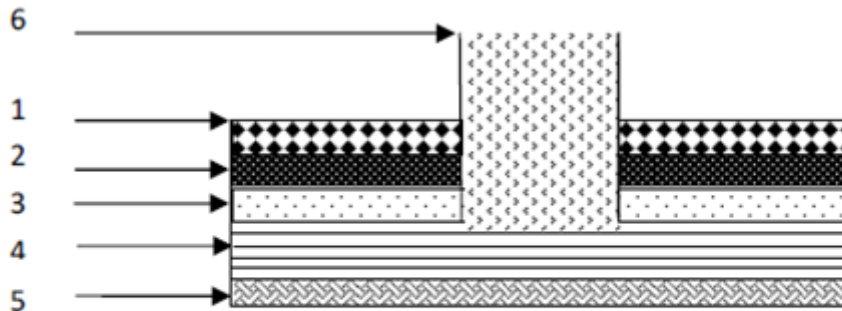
coupe d'un plancher etage courant en corps creux
